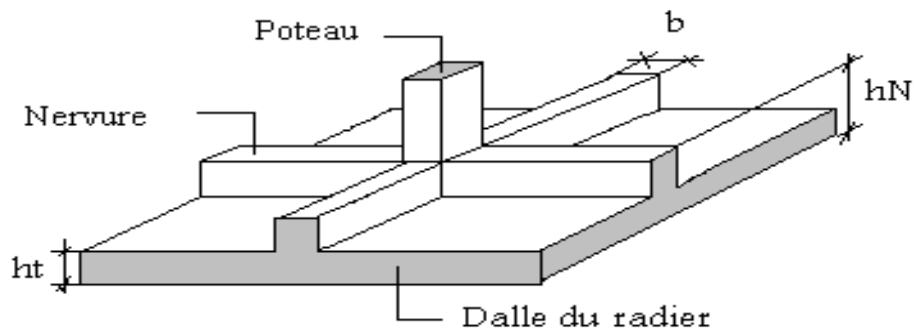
Disposition des nervures par rapport au radier et aux poteaux
